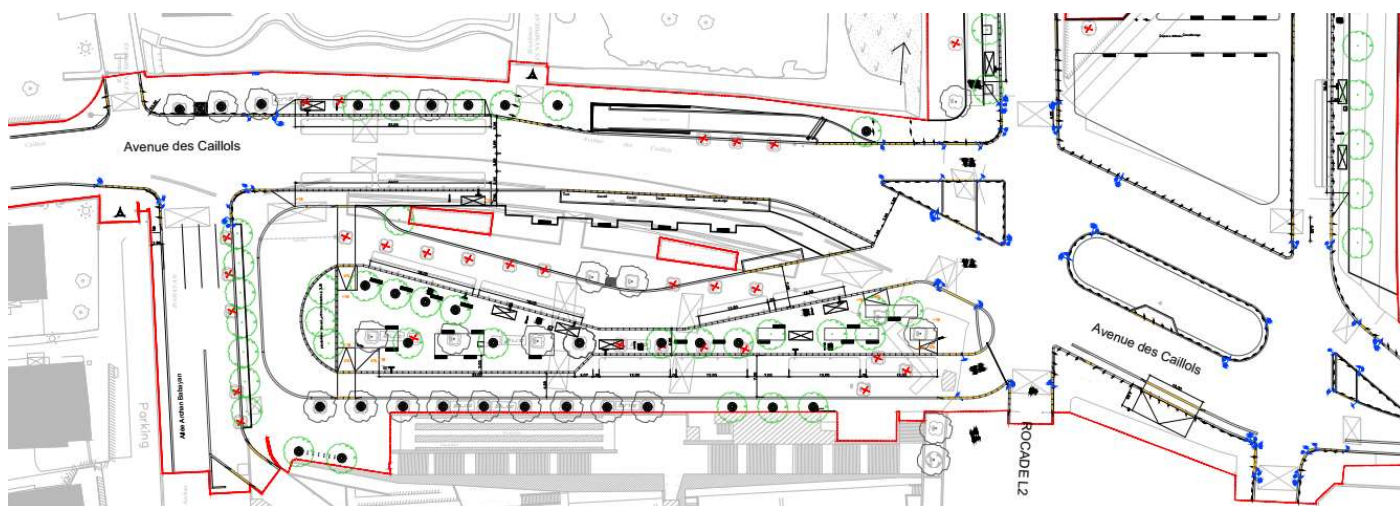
plan d'aménagement niveau DCE du secteur la Fourragère
